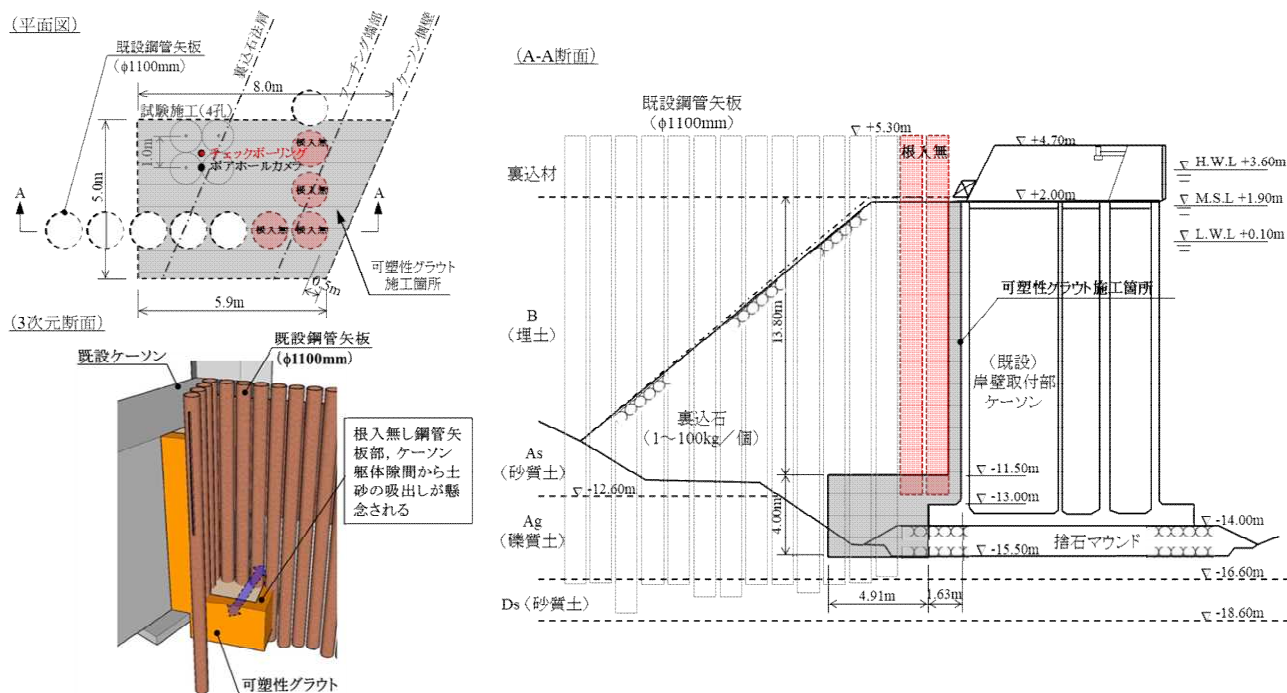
可塑性グラウトの施工範囲 (左：平面計画，右：標準断面)
